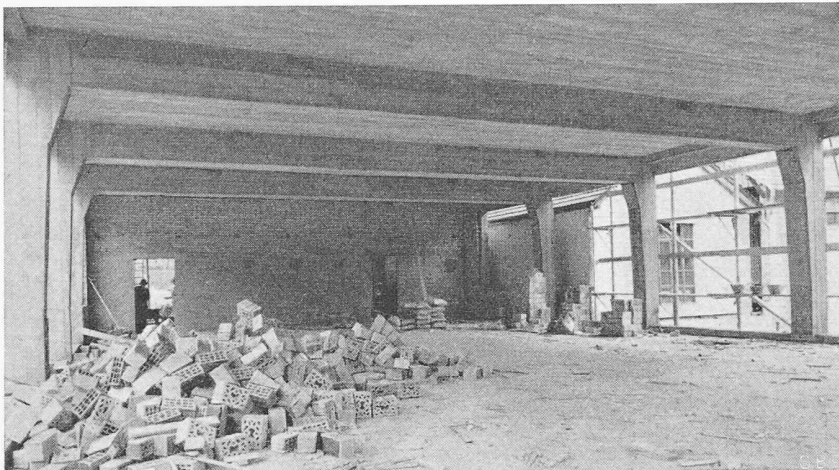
Stanzwerkzeugfabrik in Lichtensteig
